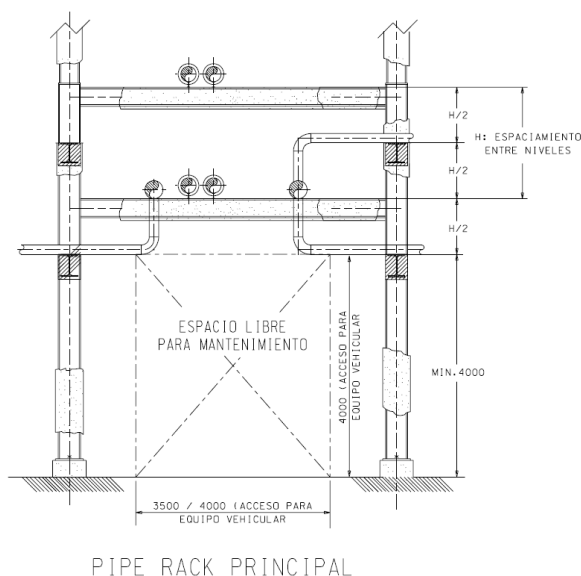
Área de Acceso Pipe Rack Principal
